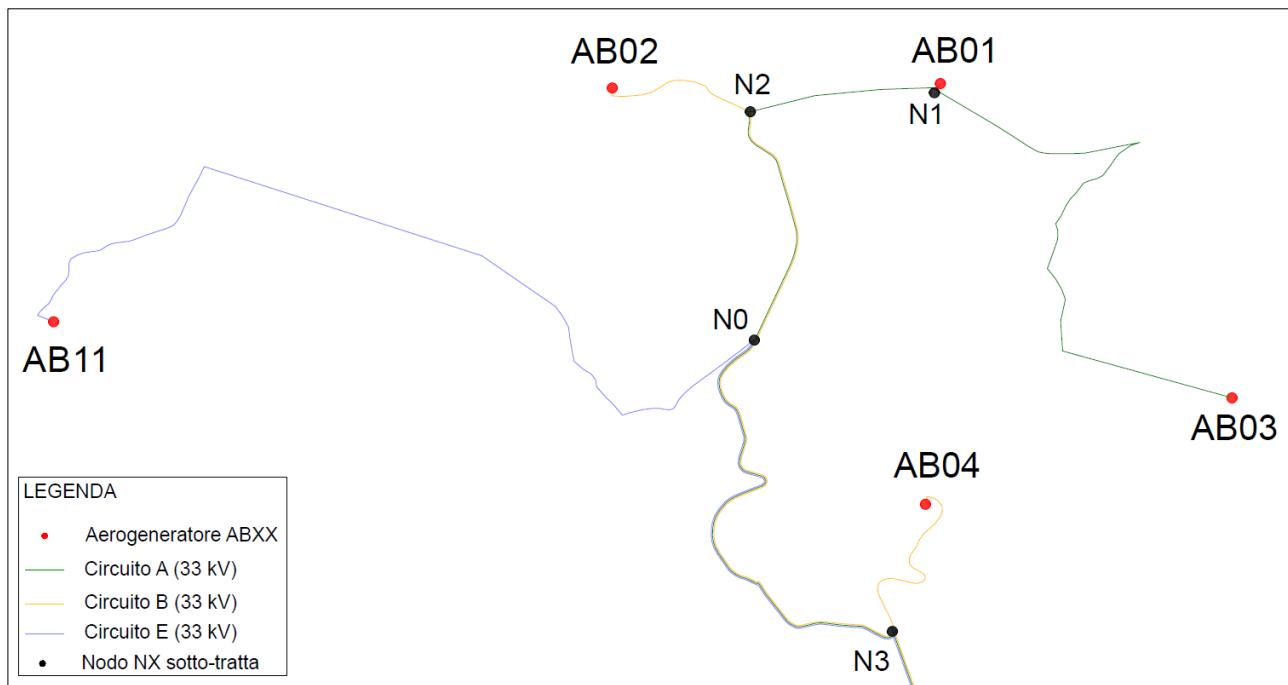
Dettaglio 1 di 4 della planimetria generale di distribuzione linee elettriche
